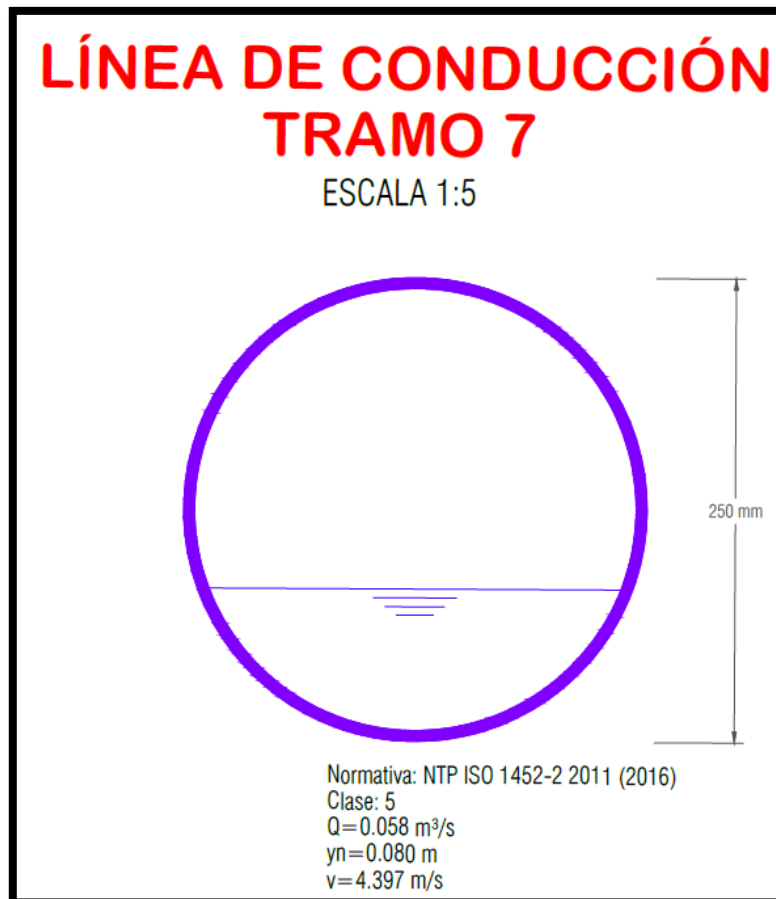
Sección típica de la tubería de PVC-U 250 mm, Tramo 7
